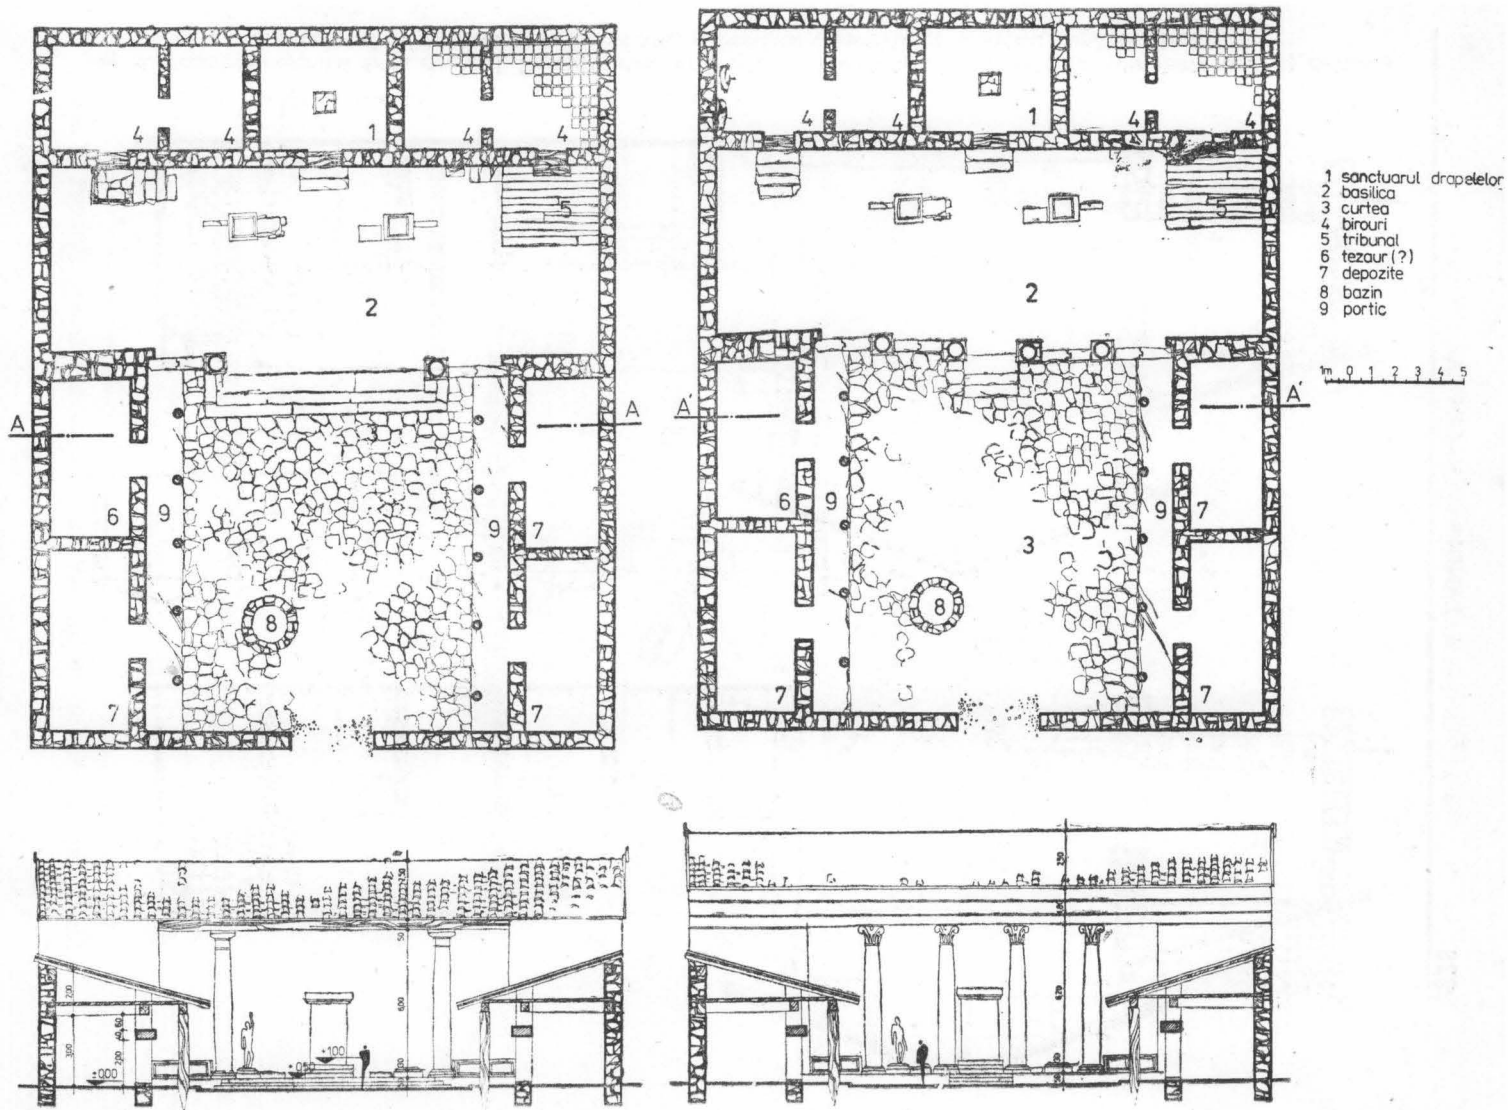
Principia castrului de la Buciumi. Variante de reconstituire. Plan și secțiune transversală.
